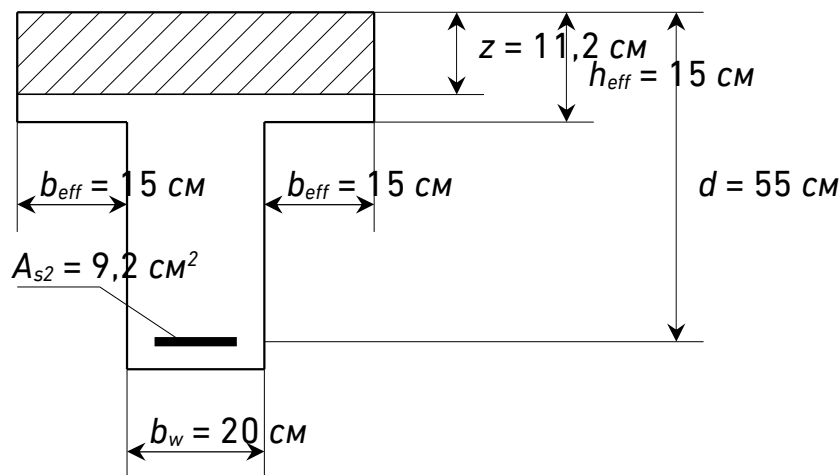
Схема поперечного перерізу елемента при положенні нейтральної лінії в полиці
